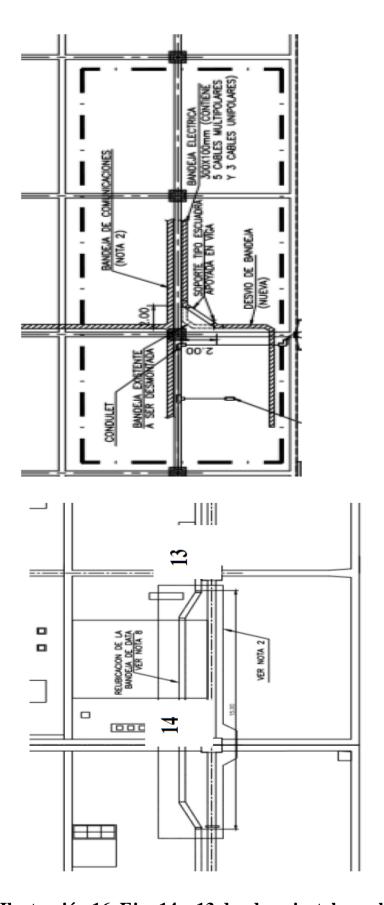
Ejes 14 y 13 donde se instalaran lo disipadores.
